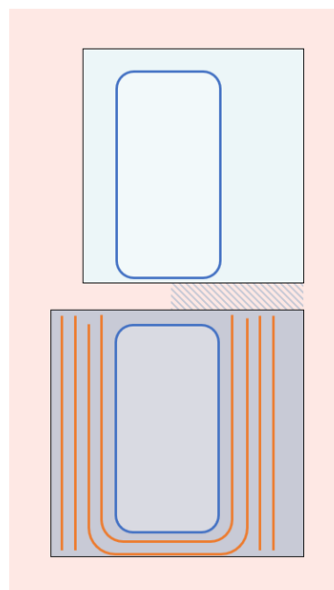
Snittet illustrerer hvordan nordlig fasade, takfasade og konstruksjon av Bergenshallen bevares og ny hall bygges i sør. Etterfølgende detaljplan må avklare om de to byggene må henge sammen, om de i så fall bygges sammen med et nedskalert overgangsvolum, eller om de kan oppføres som to separate bygg med åpen passasje mellom.
